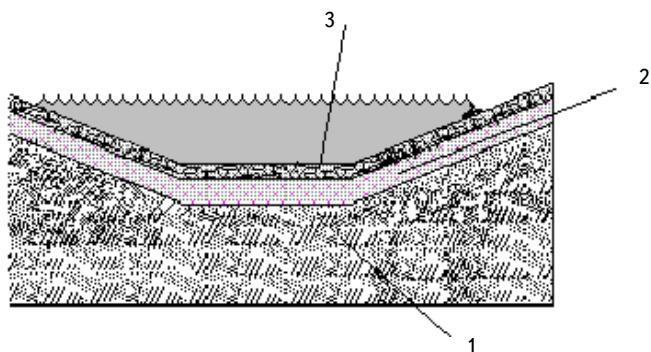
Гидроизоляция на основе бентонитового гидрогеля [110]:
